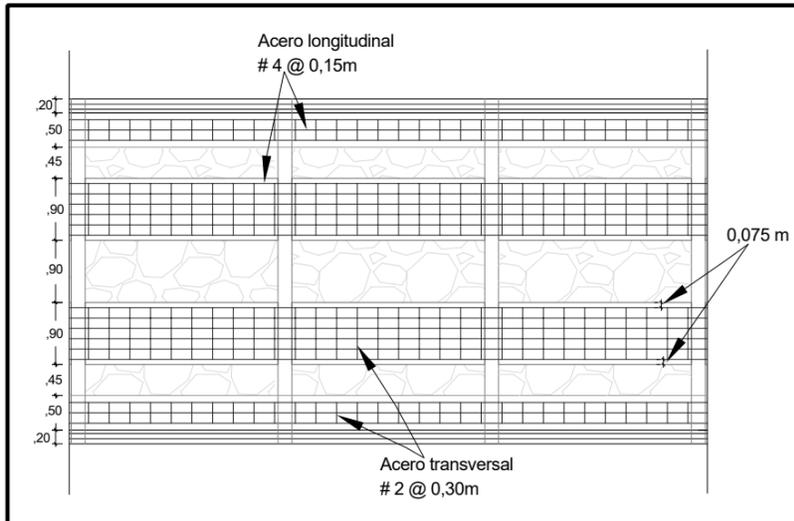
Distribución del acero de refuerzo en la placa. Corte longitudinal
